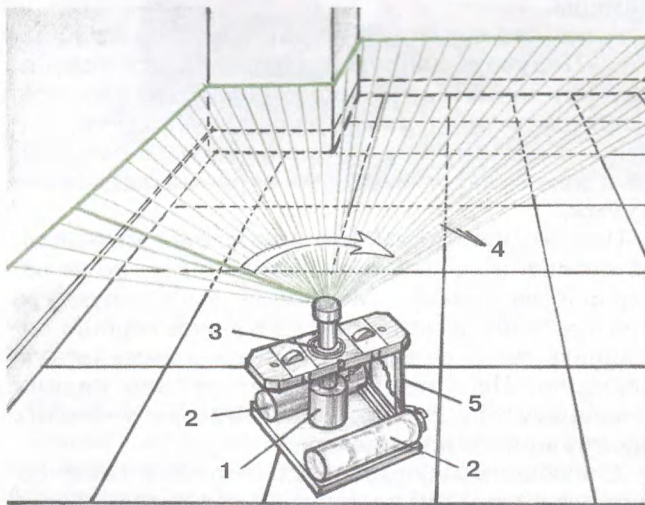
Общий вид и схема работы прибора: 1 — электродвигатель; 2 — батареи питания; 3 — плавающий узел; 4 — сканирующий луч лазера; 5 — подставка.
